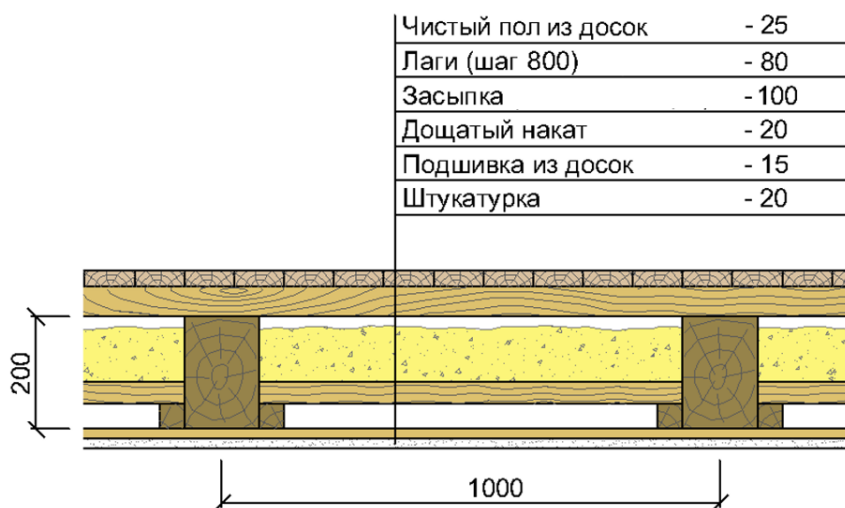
Конструкция перекрытия (сечение поперек пролета)
